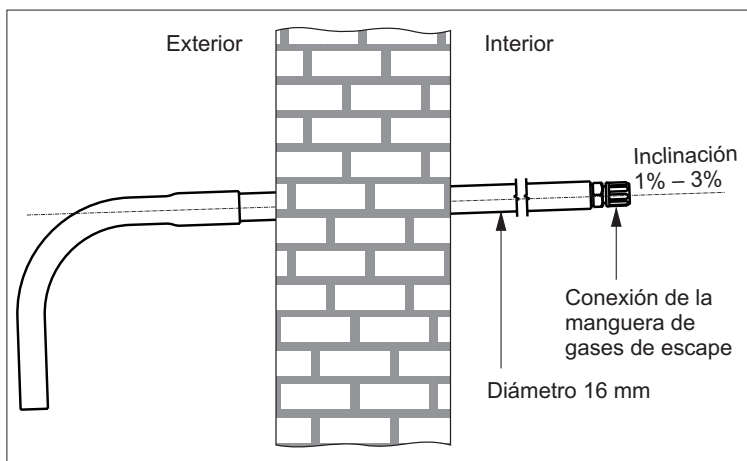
Montaje del pasamuro en un muro externo (representación esquemática)
